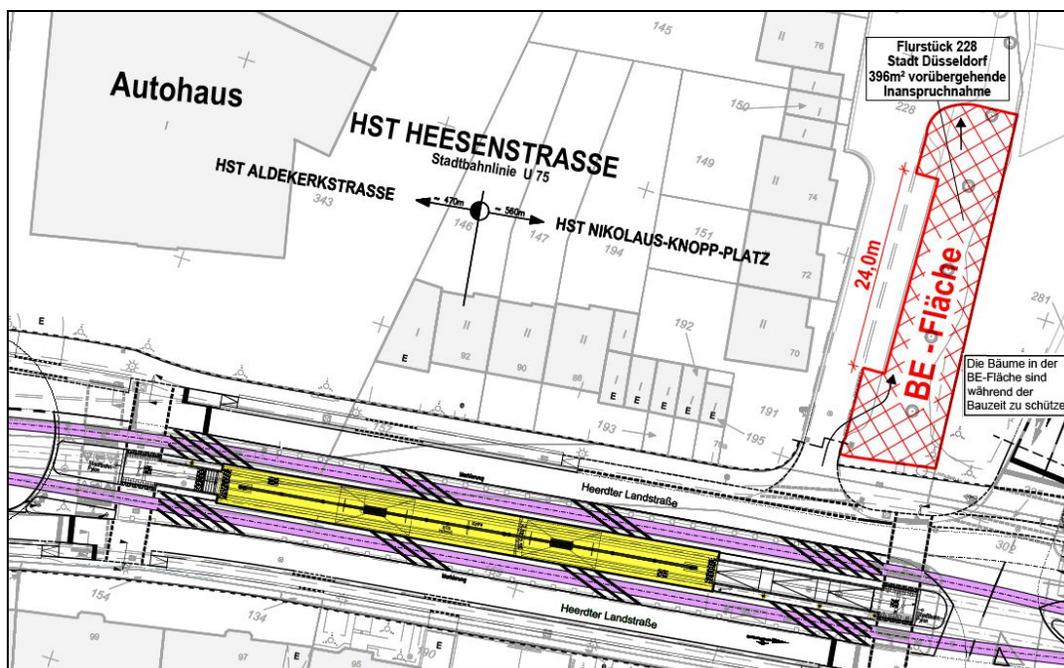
Weitere Baustelleneinrichtungsfläche Hst. Heesenstraße (WENDT Juli 2018)
